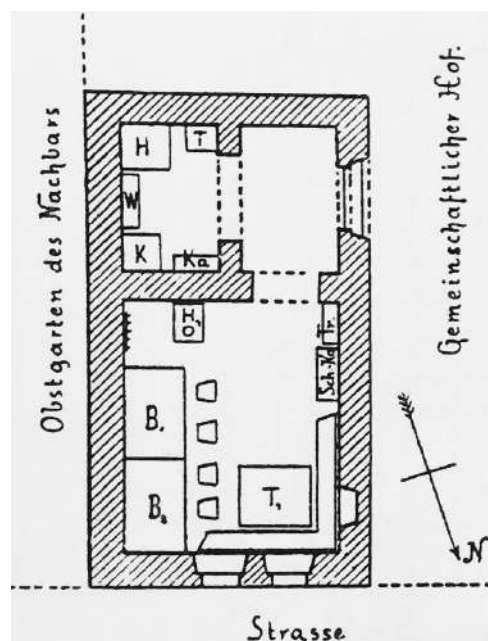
Grundriss eines zweiräumigen Hauses, 1894
